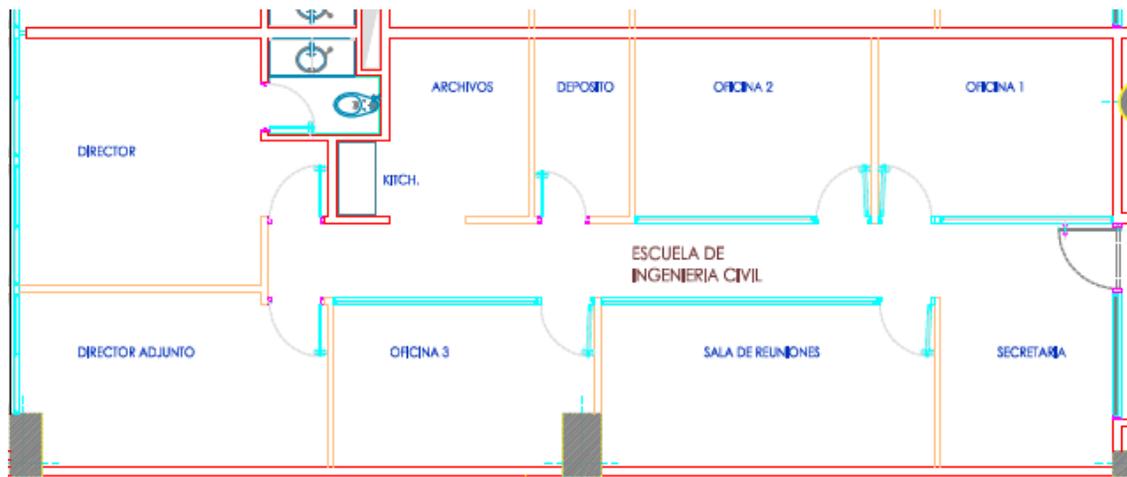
Planta Piso 2 del Nuevo Edificio Ingeniería
